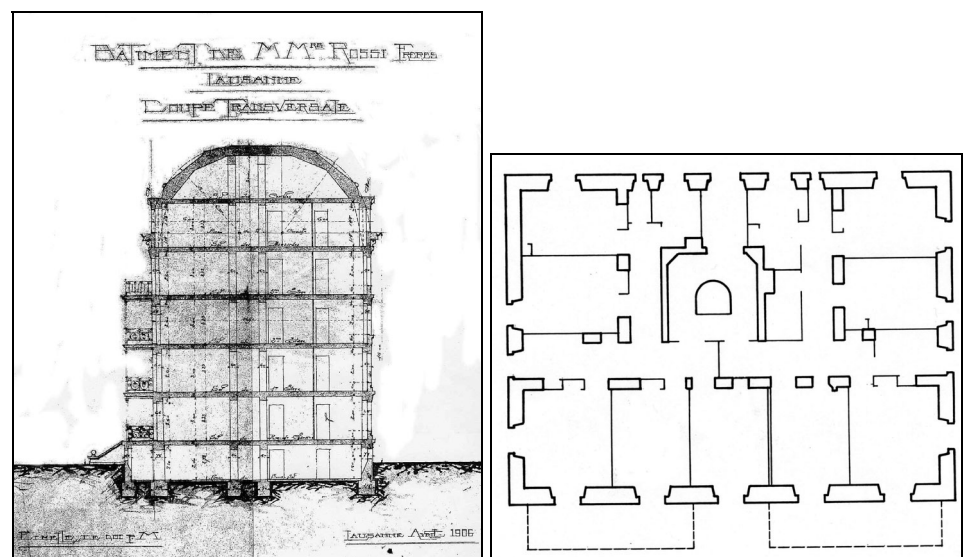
Coupe transversale et schéma du rez-de-chaussée du bâtiment Av. Dapples n°3
